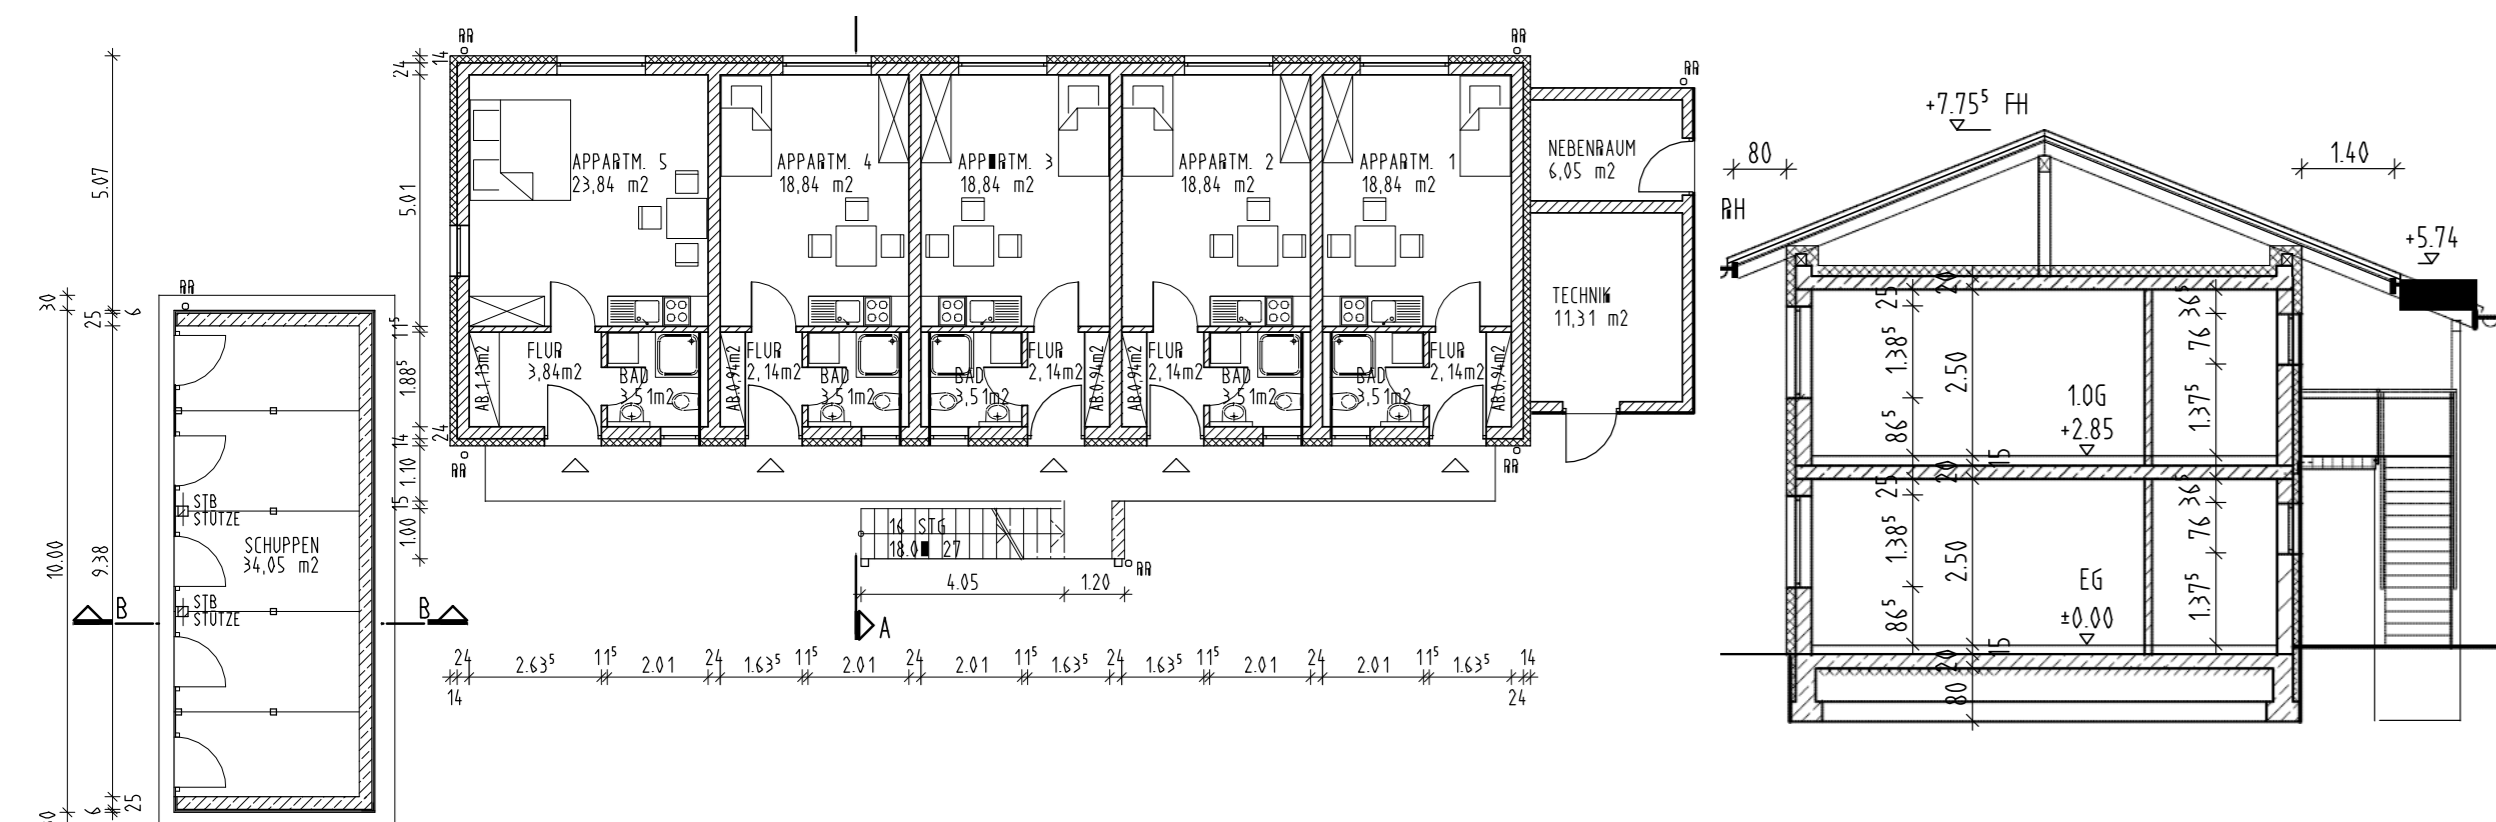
und 2: Grundriss und Schnitt des Apartmentgebäudes
